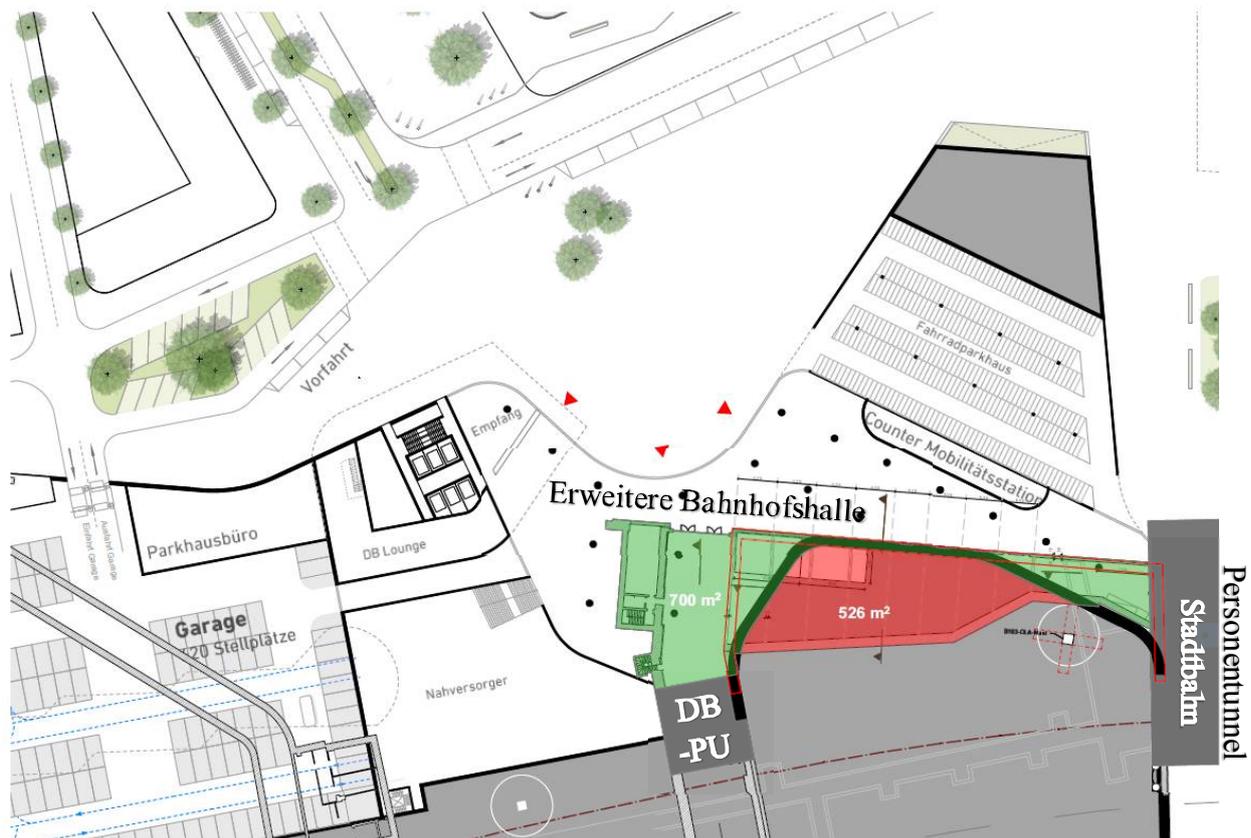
Überlagerung geplante erweiterte Bahnhofshalle mit bislang geplantem Verbindungsbauwerk, verbleibender Erdkern rot markiert
